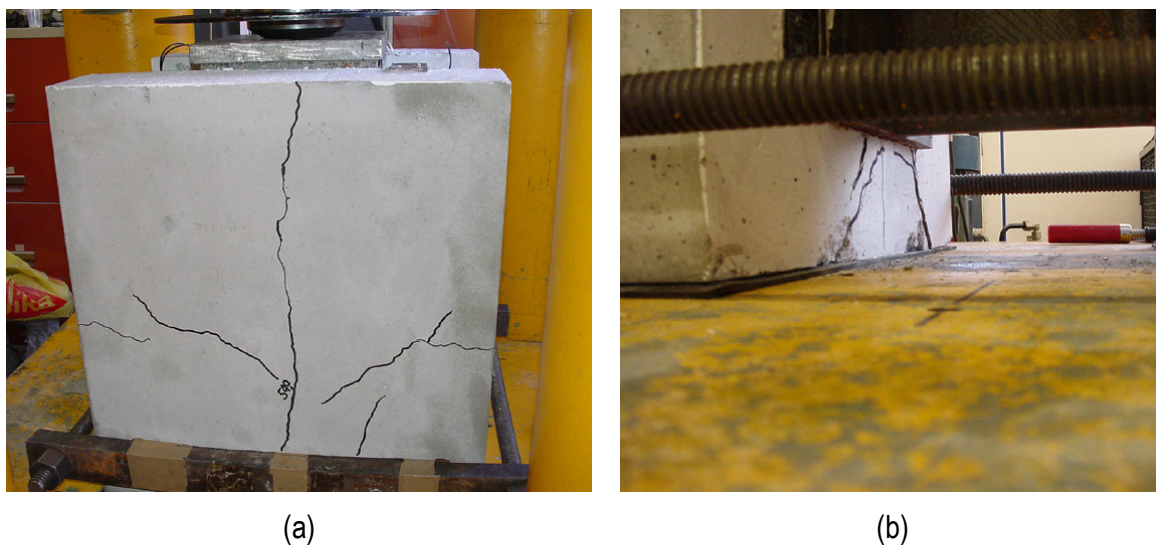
Fissuração da laje no modelo A1.
